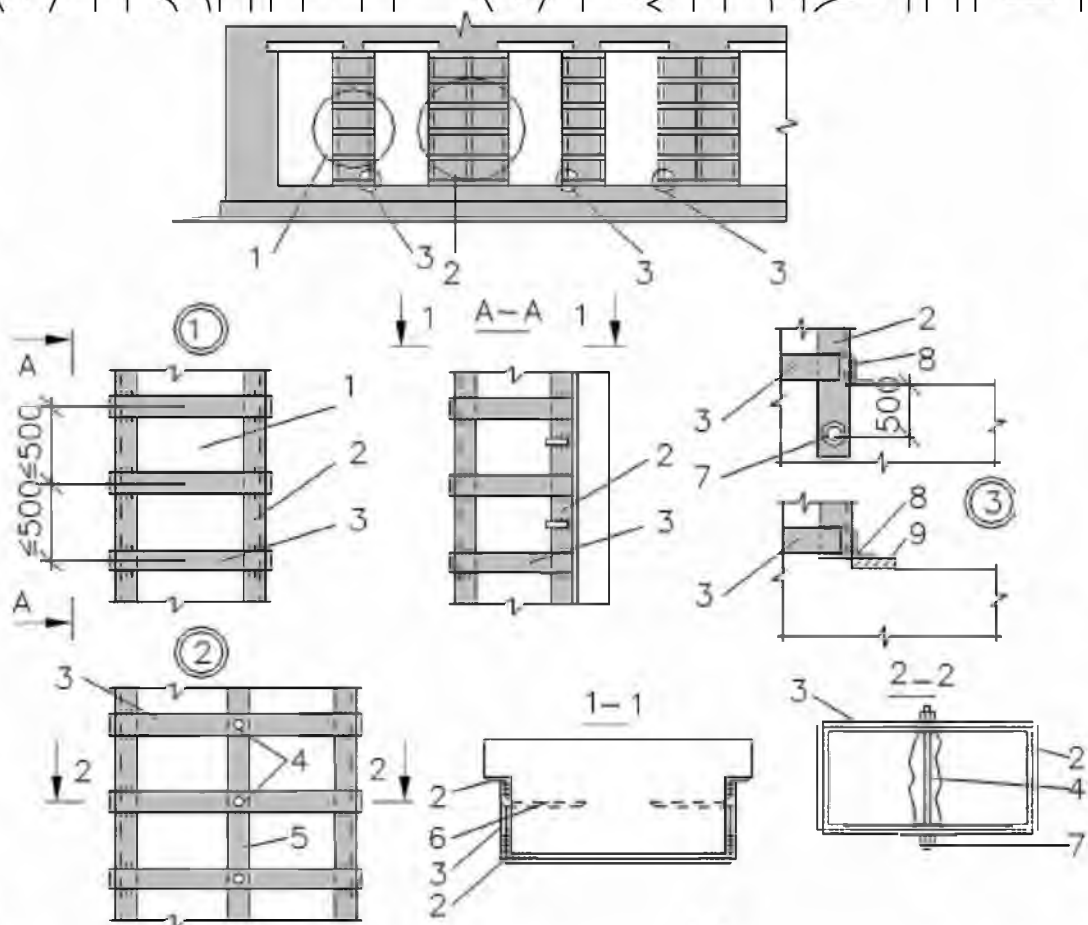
Посилення кам'яних конструкцій сталеву обіймою: 1 – посилена конструкція; 2 – металевий куттик; 3 – планка; 4 – поперечний зв'язок; 5 – полоса; 6 – анкери; 7 – болт; 8 – опорний куттик; 9 – сталевая пластина
